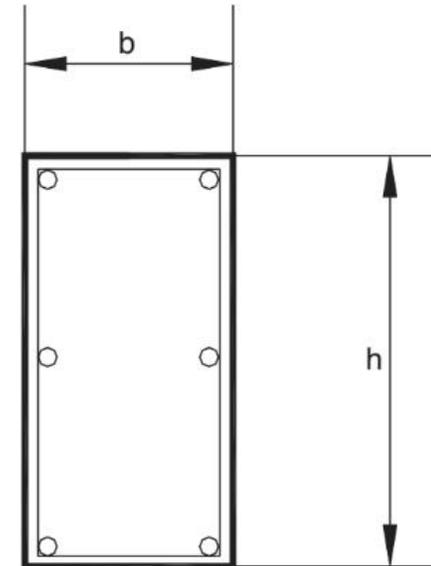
Norma empleada: Standard specifications for tolerance for concrete construction, ACI 117, sección 4.
